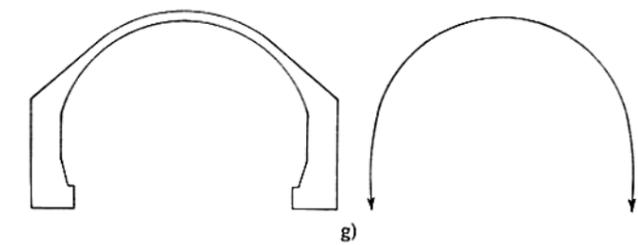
Tunnelgewölbe aus reinem Stampfbeton.
